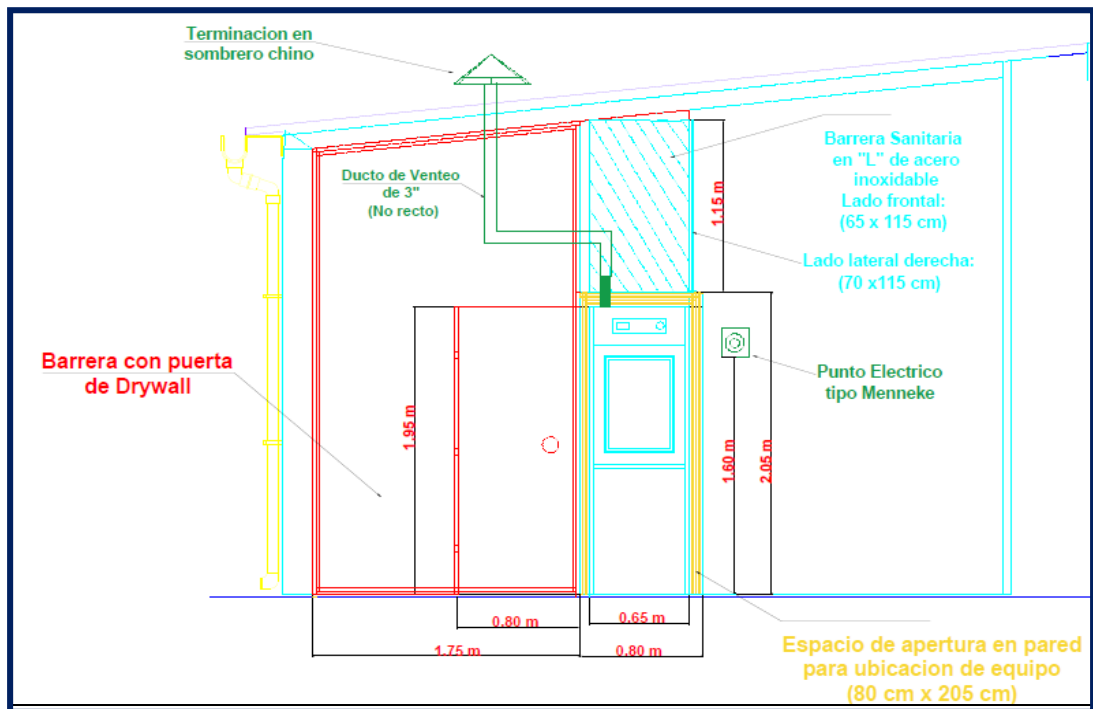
Plano 02 de Preinstalación – Área Roja. Fuente: propia
